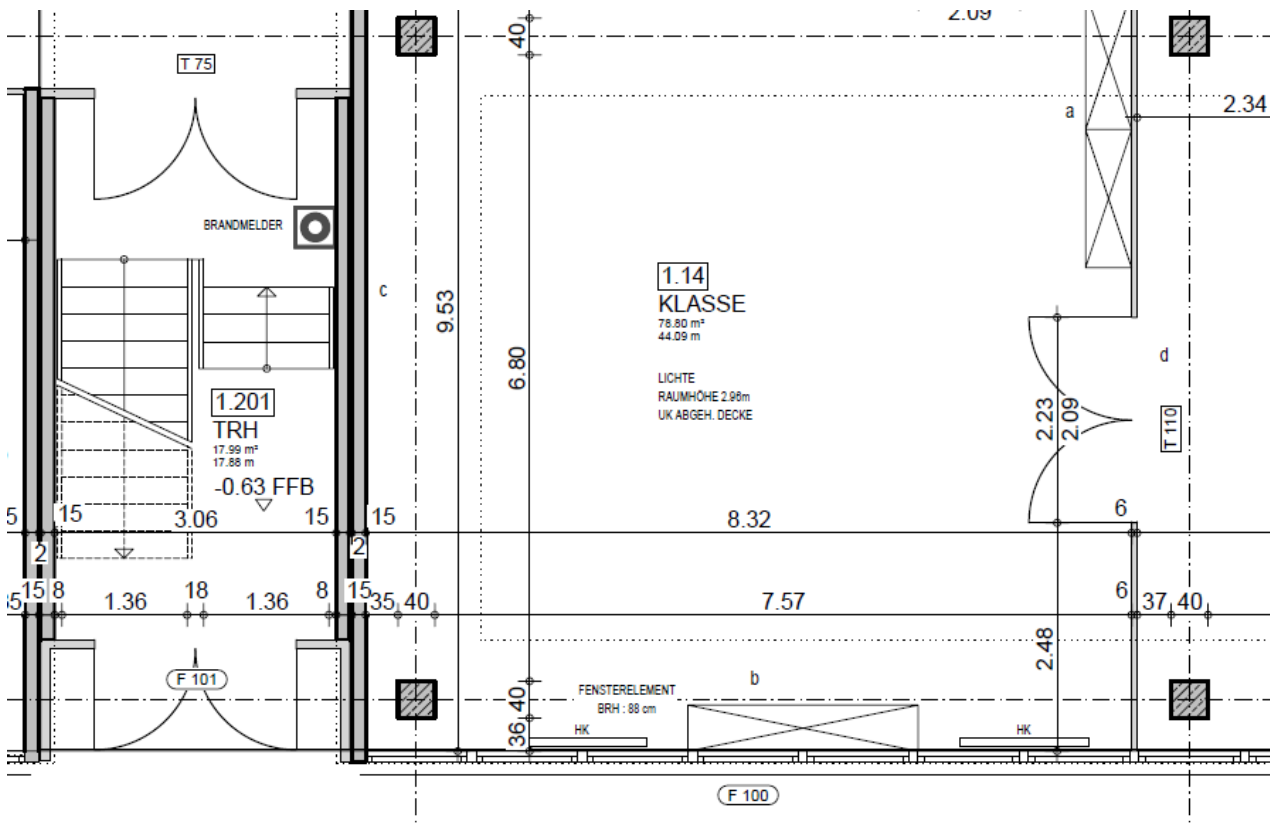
Ausschnitt Plan mit Codierung: Bestand EG A1, A2
